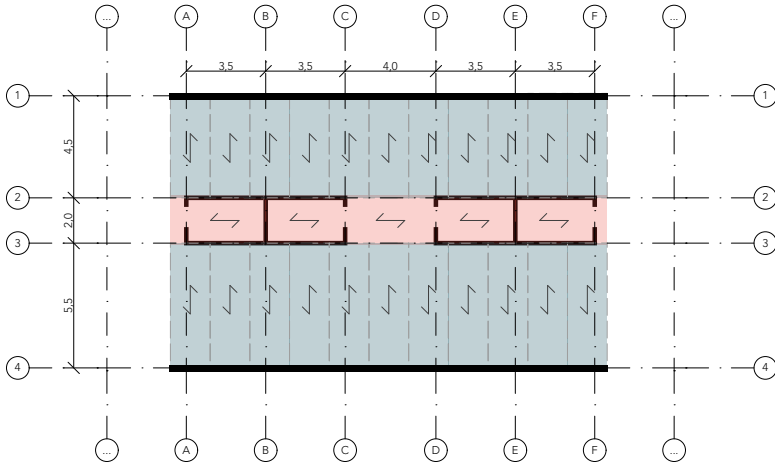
Statisches Konzept - Tragende Wände und Decken
